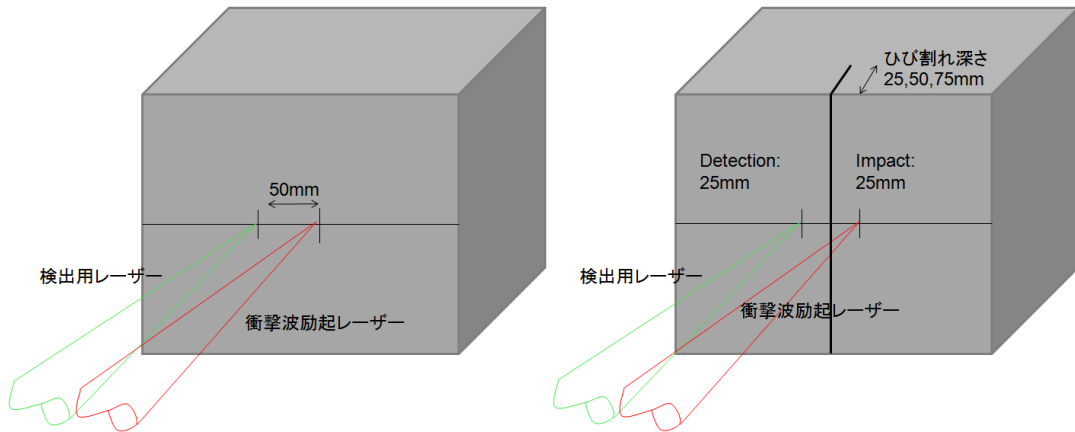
レーザー照射配置 (左) ひび割れ無し供試体 (右) ひび割れ有り供試体
